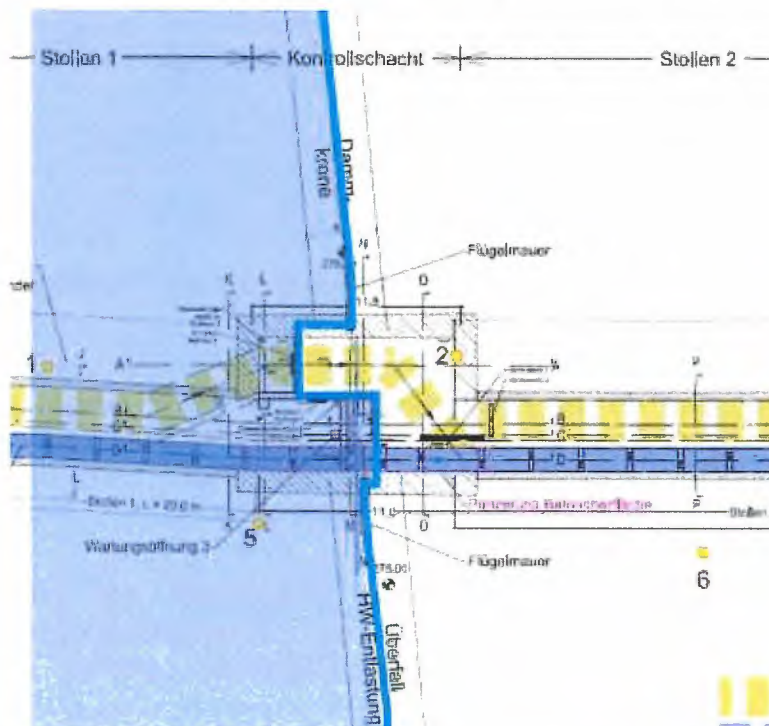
Wasserdichte Ebene (Grundriss); aus Bericht Vorbemessung
